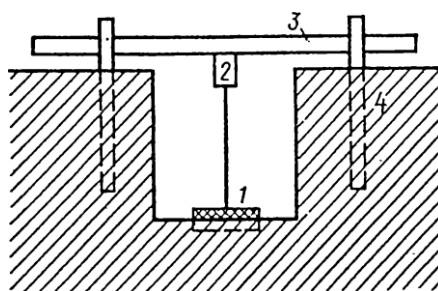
Схема установки для испытания грунтов опытной нагрузкой: 1 — штамп; 2 — домкрат; 3 — балка; 4 — анкерная свая
